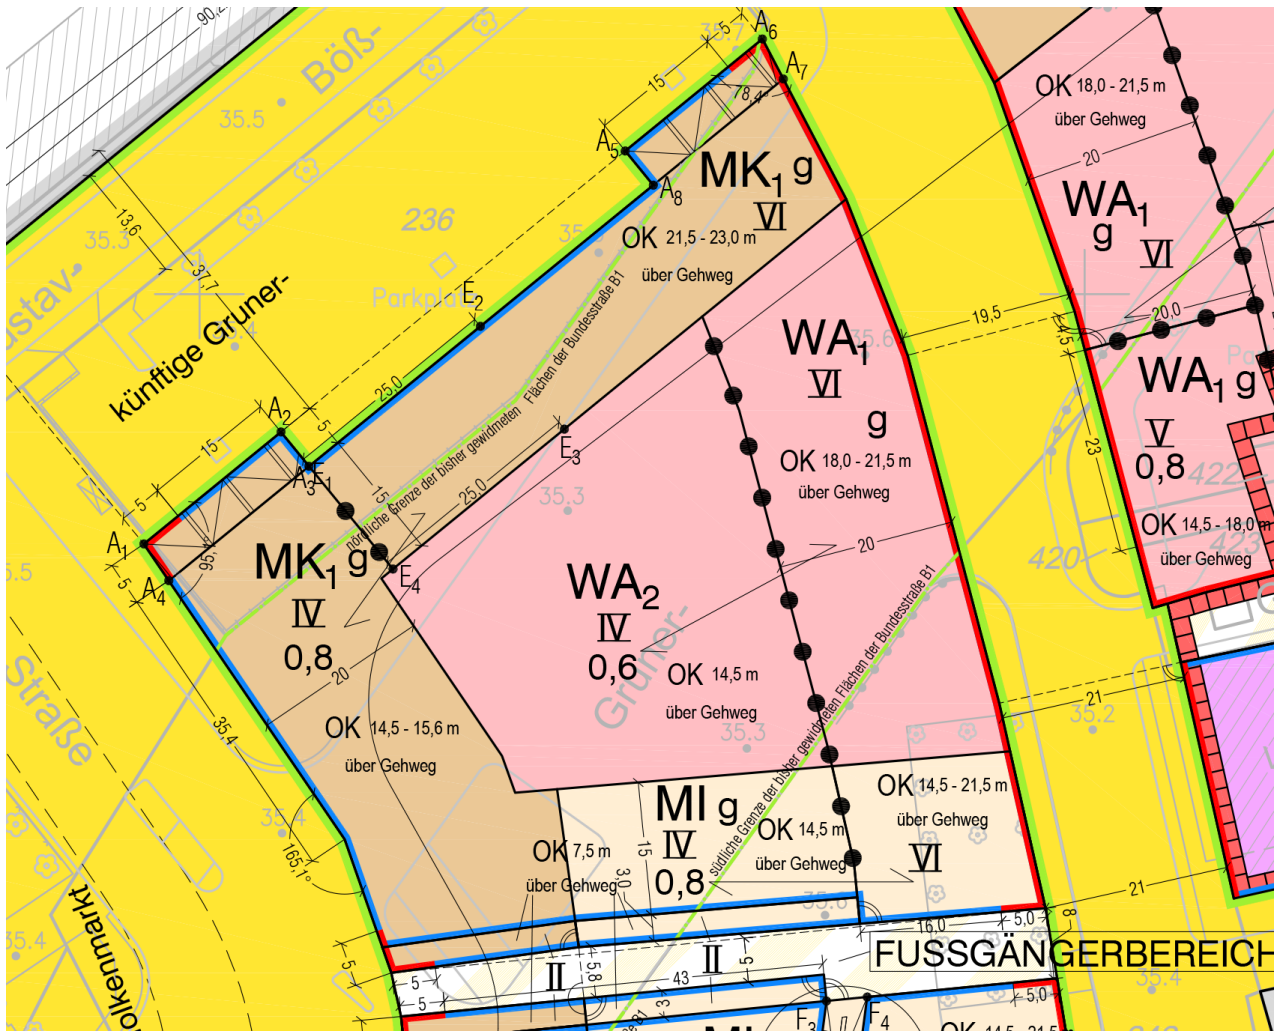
Ausschnitt Block B im Bebauungsplan 1-14
